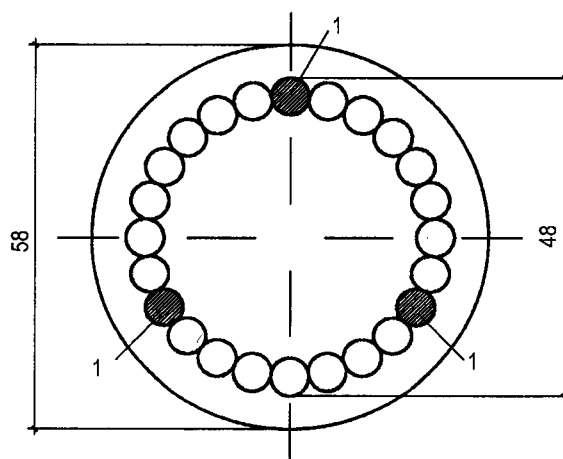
Bố trí cốt thép khi sản xuất cấu kiện trên bàn rung
